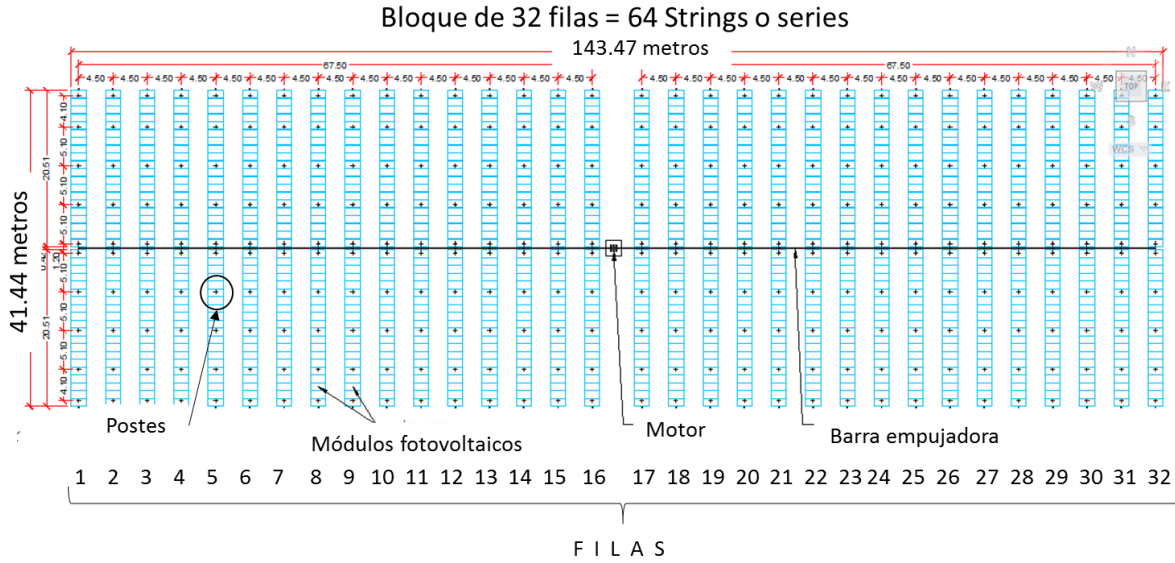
FIGURA ARMADO DE UN BLOQUE DE 32 FILAS Y 64 STRINGS
